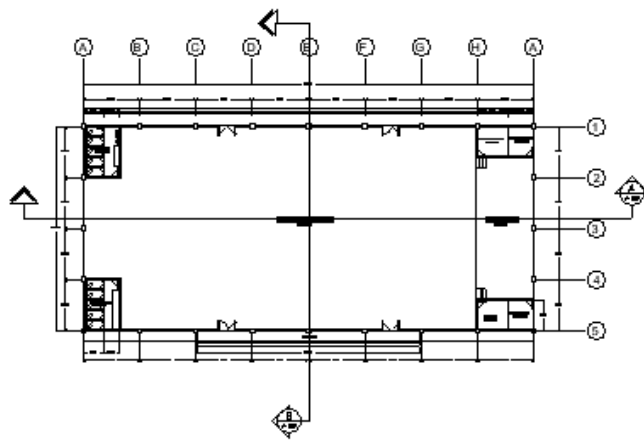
Denah Lt. Tipikal Gedung D
